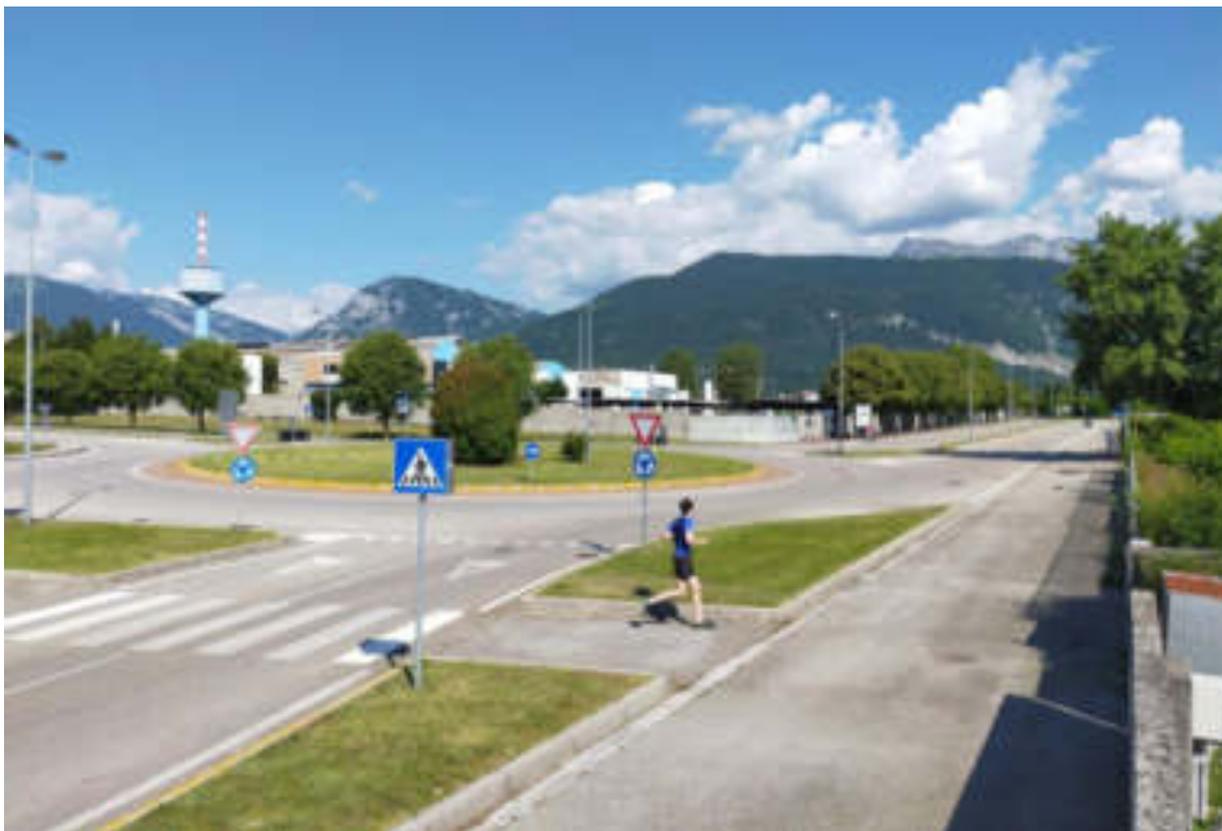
Vista da via dell'Industria in direzione nord della rotonda / incrocio con via Venezia
